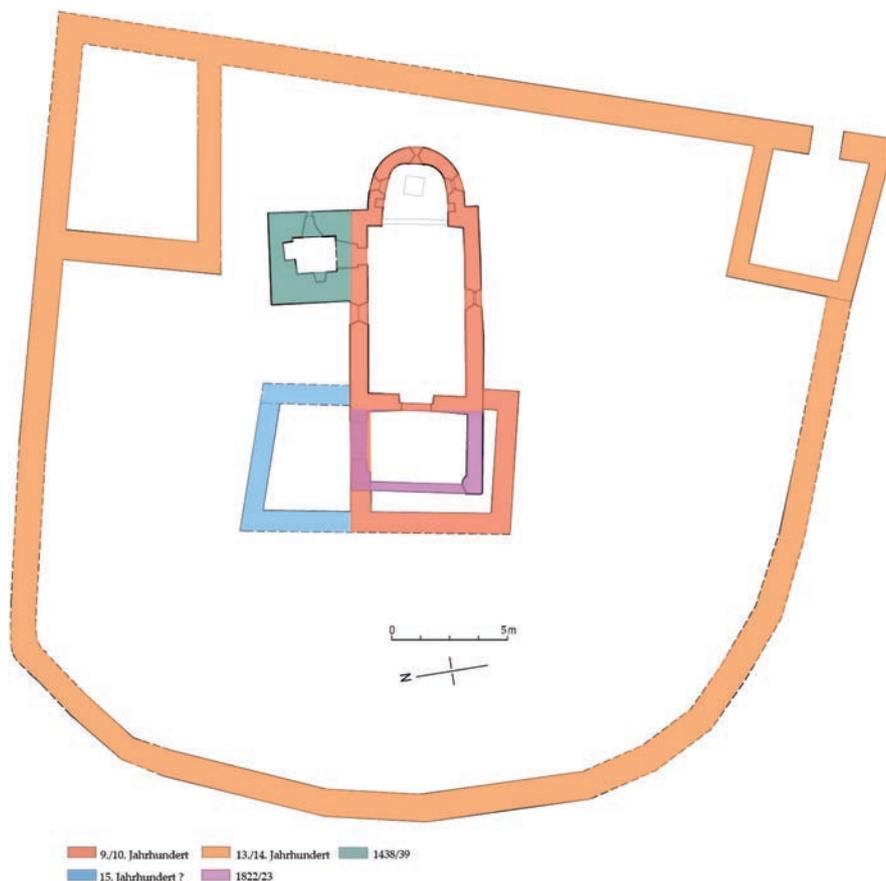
Situationsplan mit Kapellengrundriss und archäologischen Befunden.
